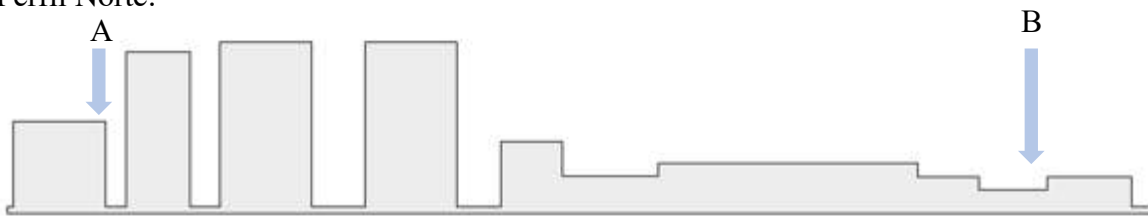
Alzado conceptual perfil norte. Acera norte Eje 10 Sur Copilco.
